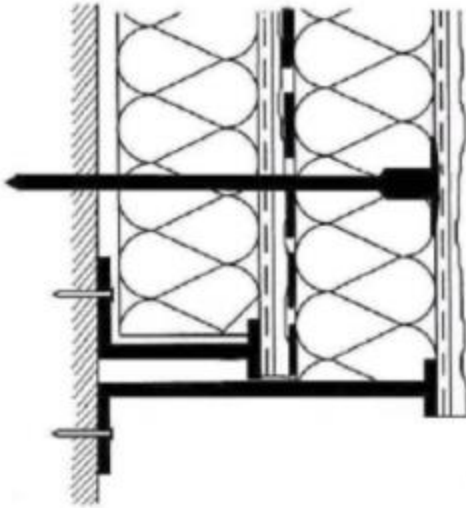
Juxtaposition des poses horizontales et verticales des panneaux isolants sur une même façade
